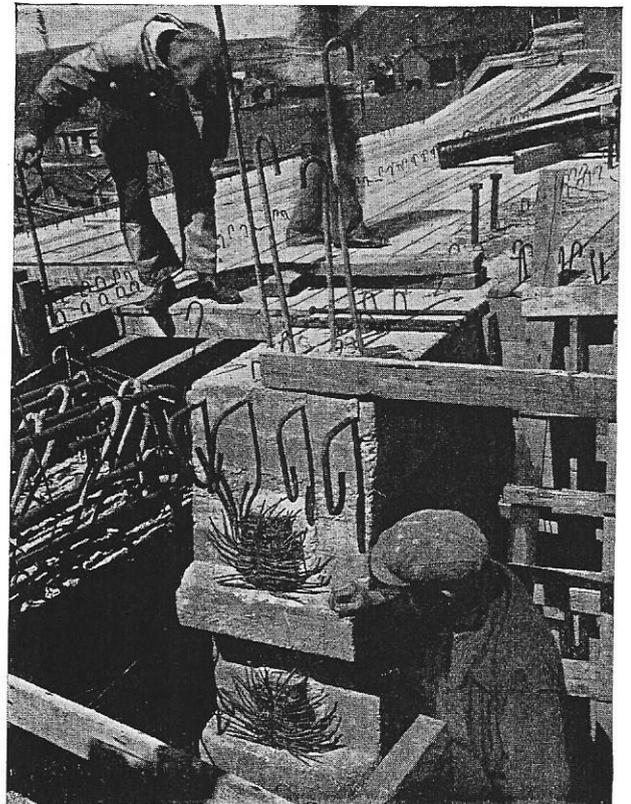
ABOUT DES POUTRES SOUS VOIES. Les dispositifs d'ancrage des fils sont nettement visibles.
